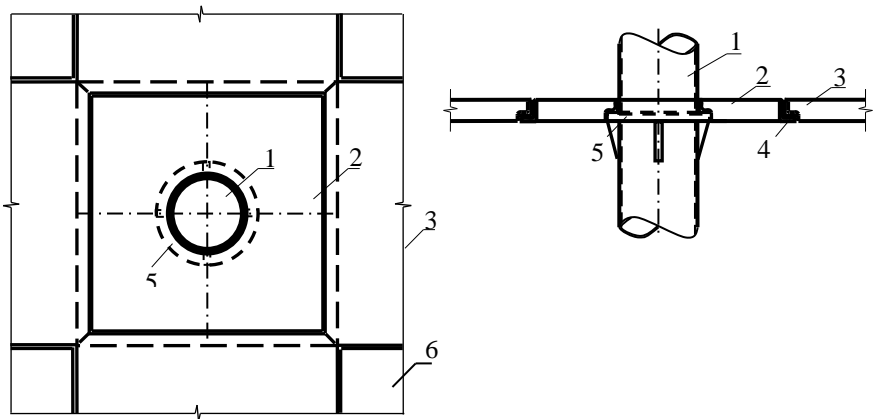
Фрагмент збірного сталезалізобетонного безбалкового перекриття:
